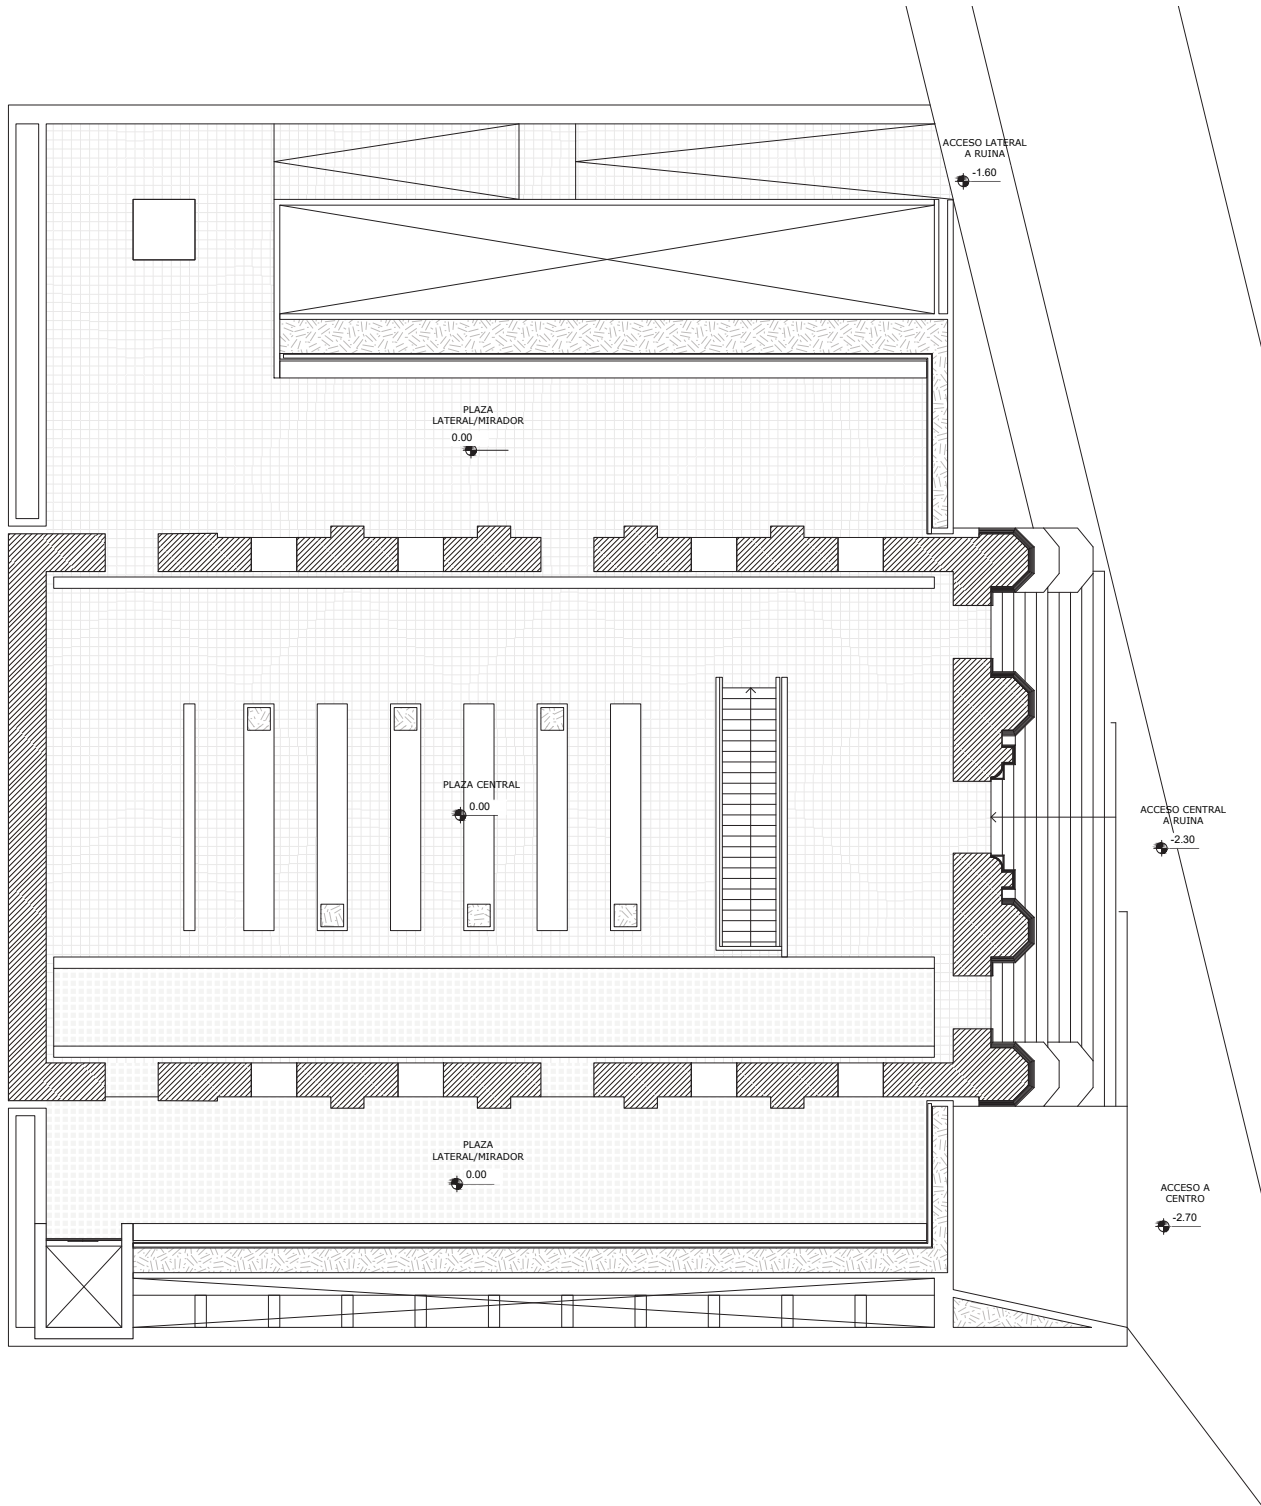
Planta nivel 1 (ruina). Esc.1:200. PRELIMINAR.
